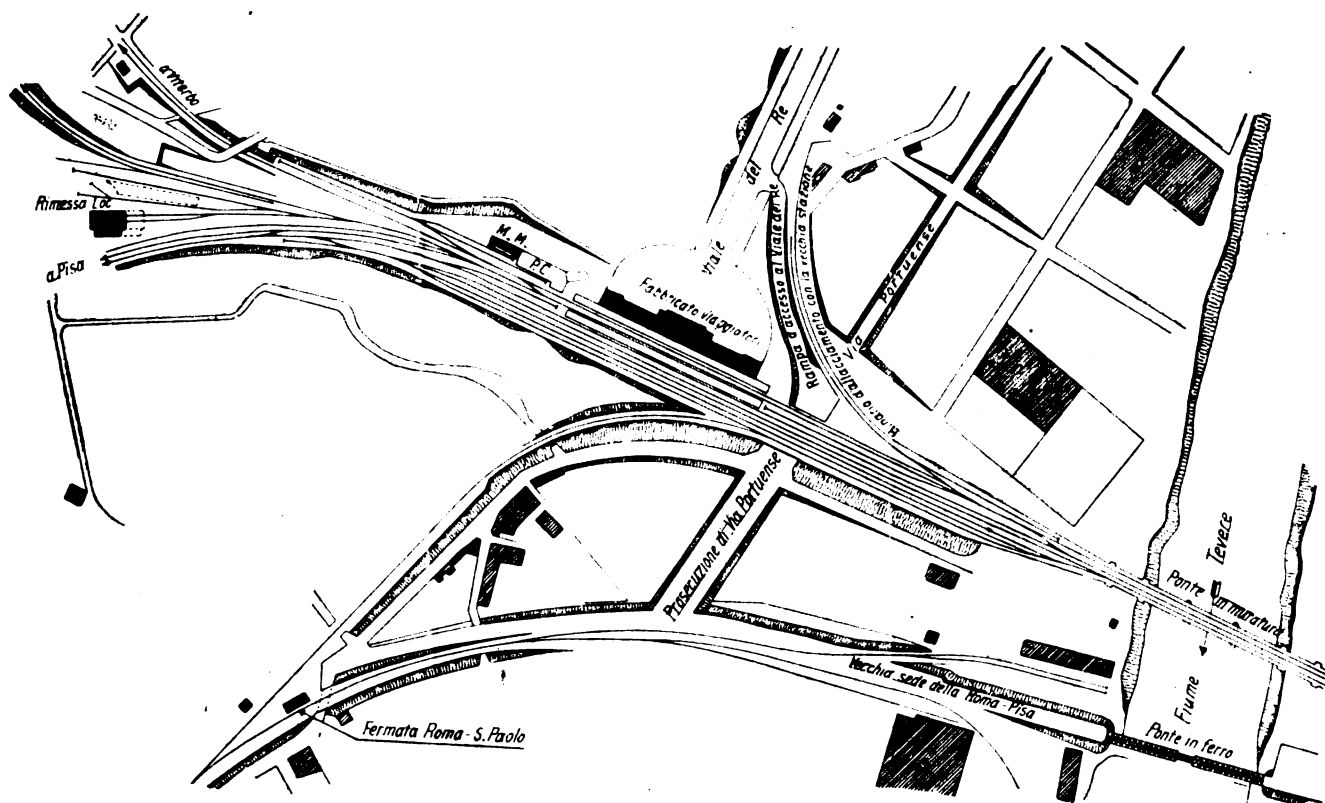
Nuova Stazione di Trastevere - Planimetria generale.
